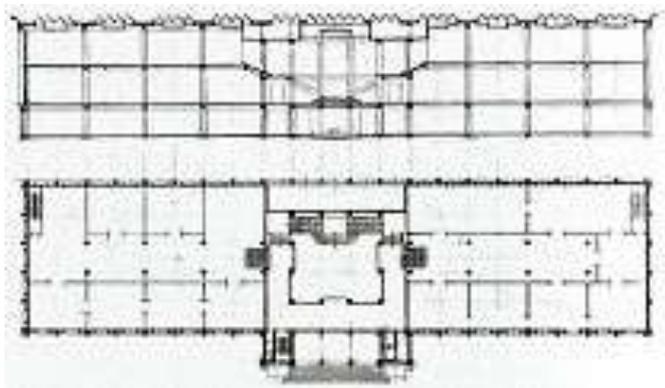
Planta do 1º pavto. E corte longitudinal do Museu de Belas-Artes de São Paulo, 1947-49.
